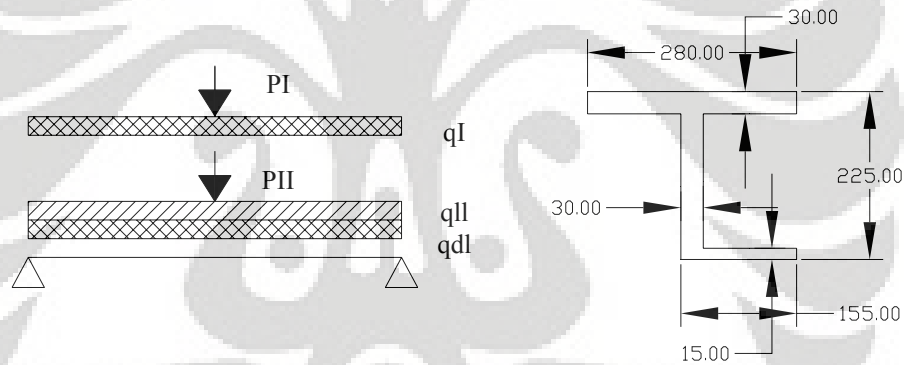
Penampang Girder Jembatan 4 Lajur 2 Arah
